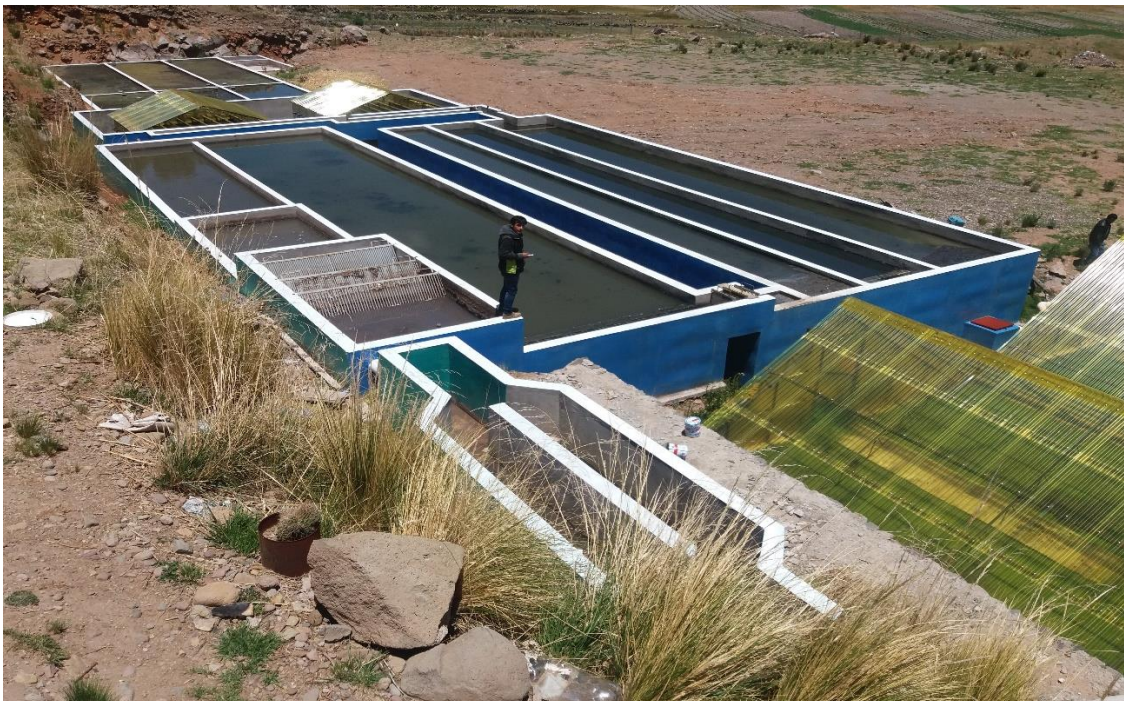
Planta de tratamiento de aguas residuales 2 – Sur
